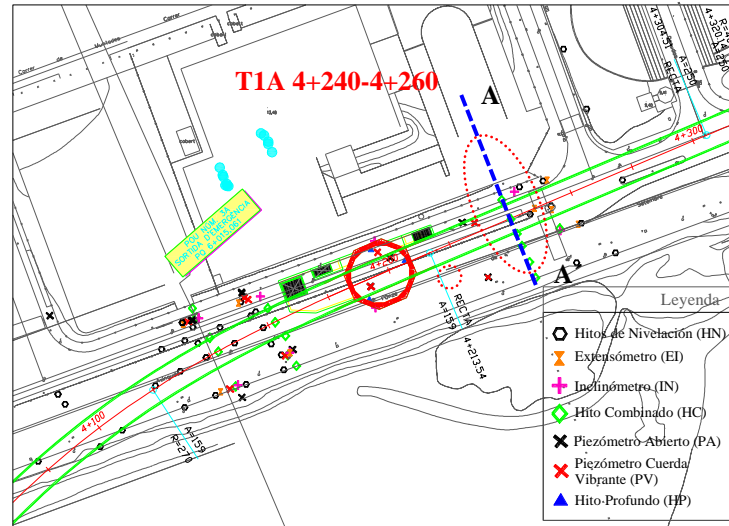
33. Situación en planta del túnel y la sección de control T1A PK 4+240
